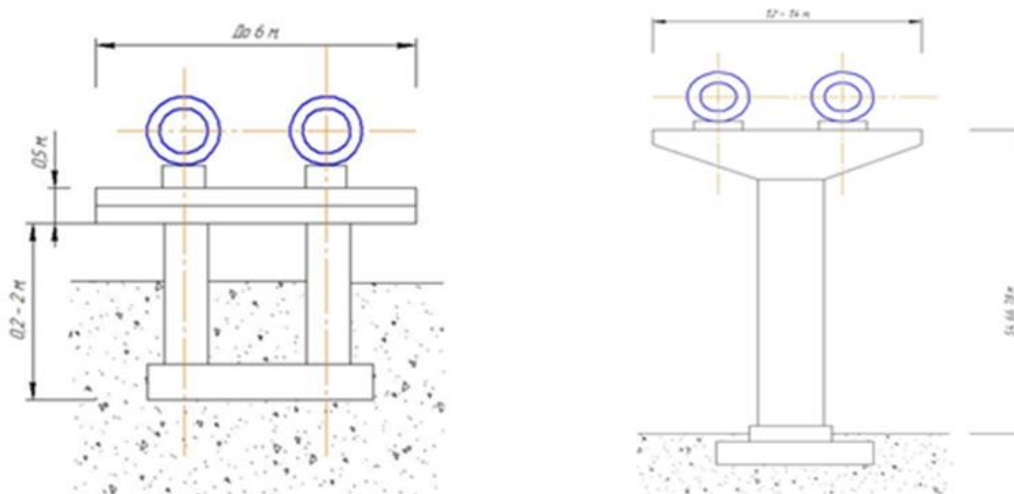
Надземна прокладка теплотраси на високих стандартних Т-подібних залізобетонних опорах
